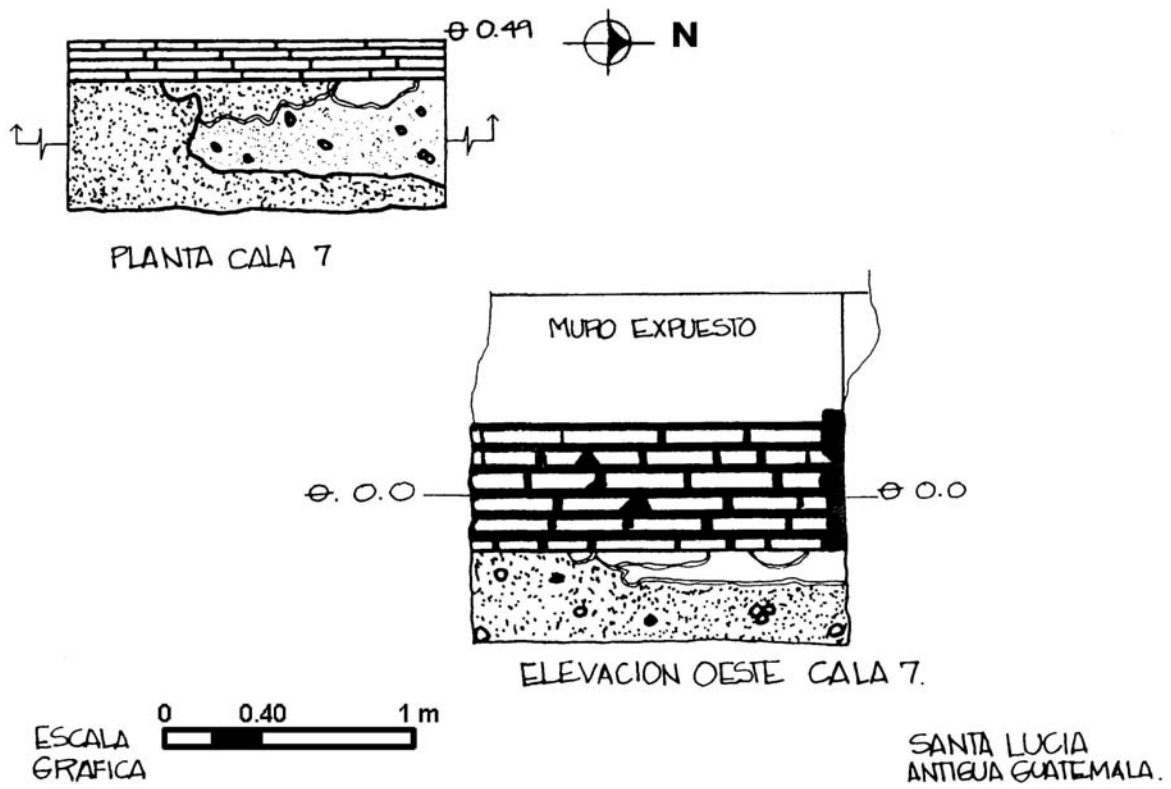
Muro de las ruinas de la Ermita de Santa Lucía
